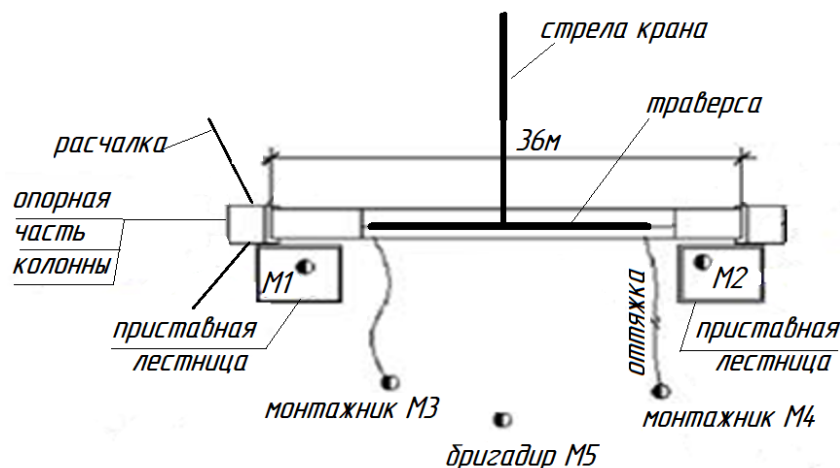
Схема организации рабочего места при монтаже фермы
